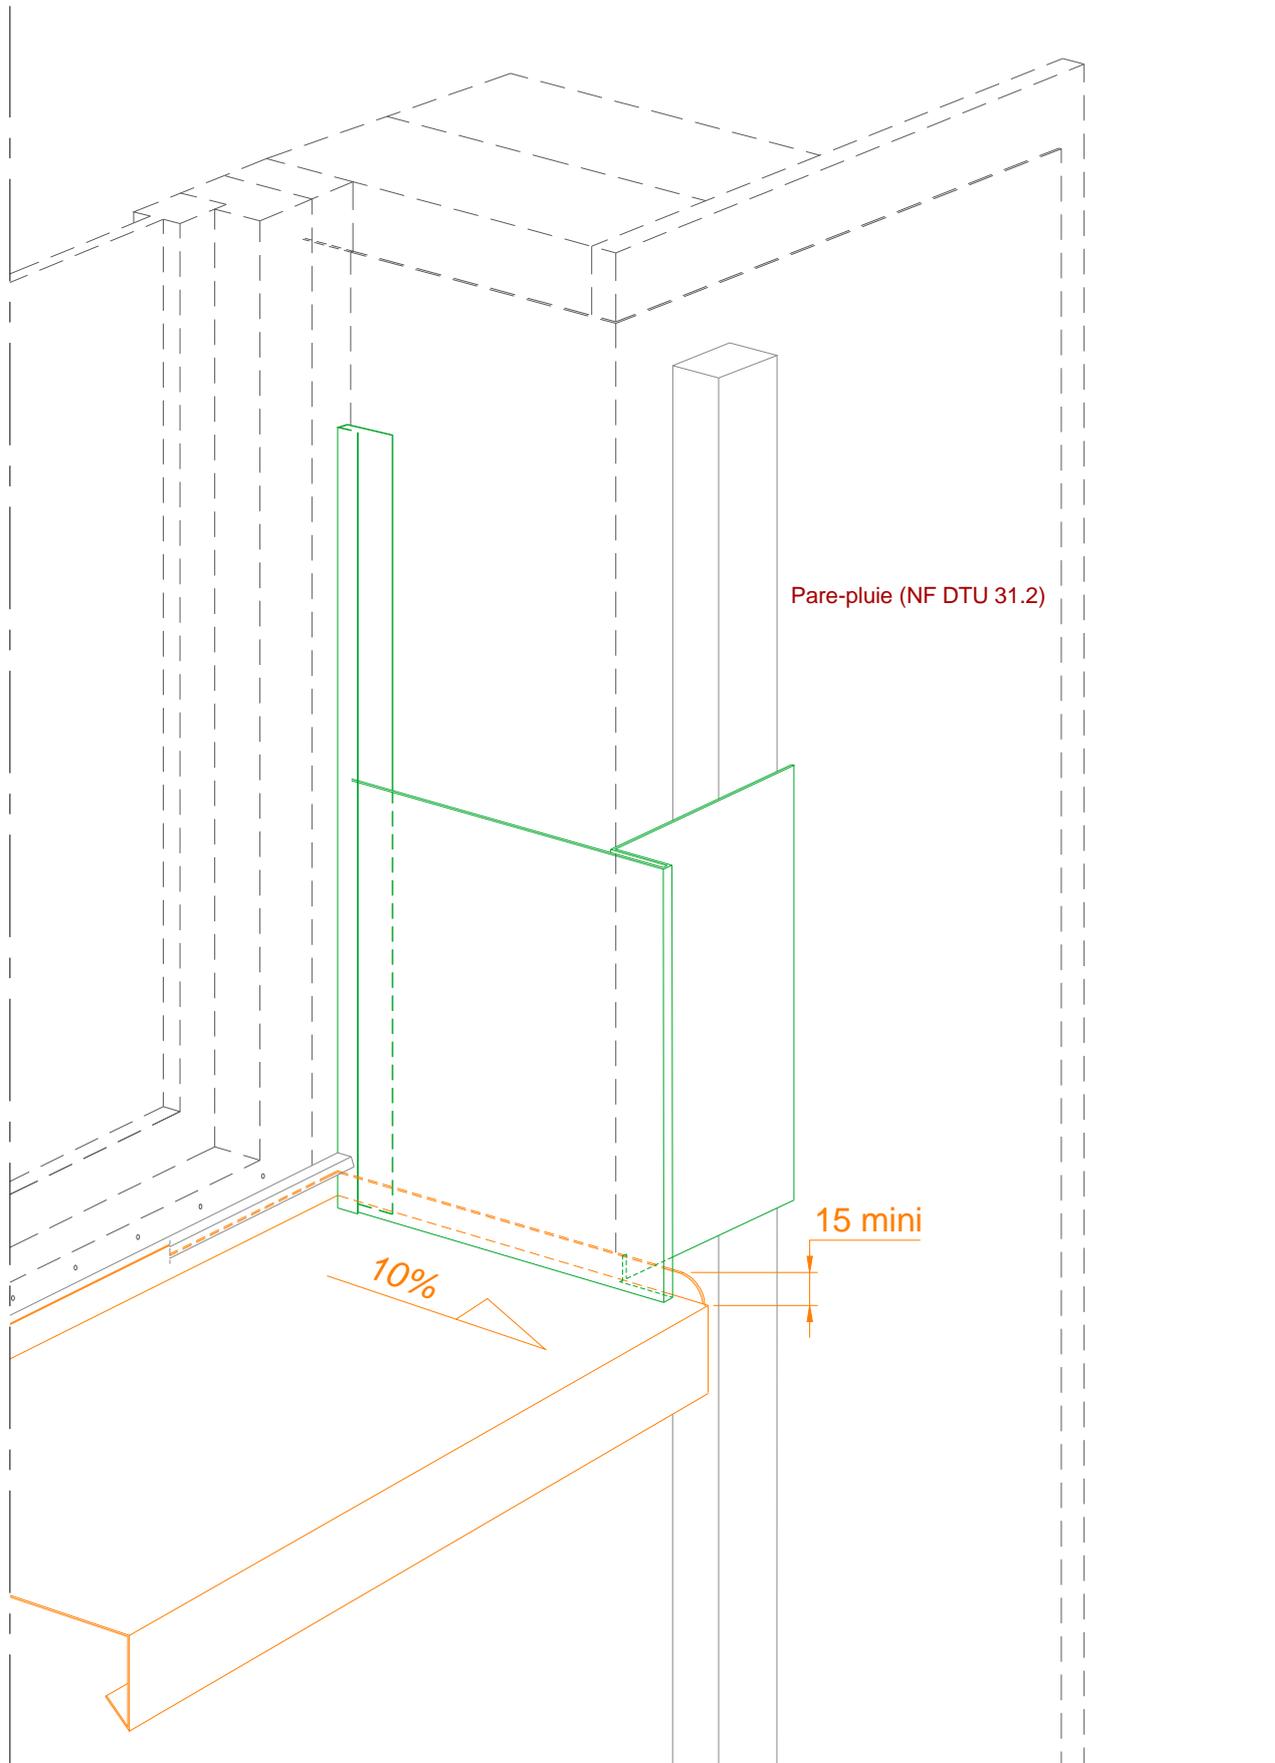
Pose sur COB – Coupe sur appui de baie
